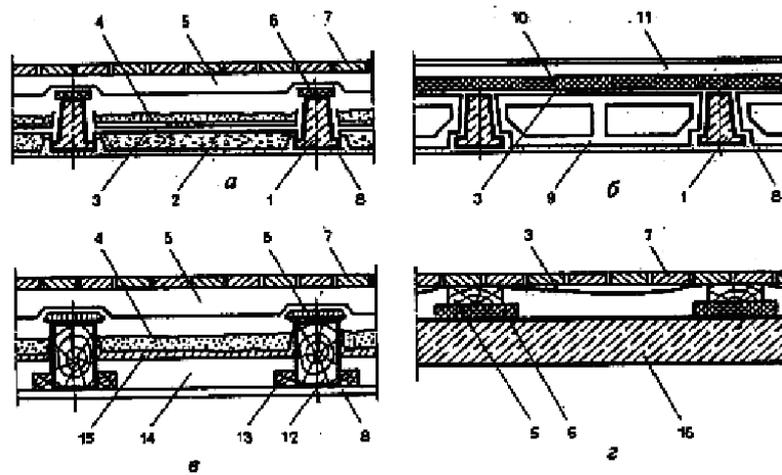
Варианты конструкции междуэтажного перекрытия:
